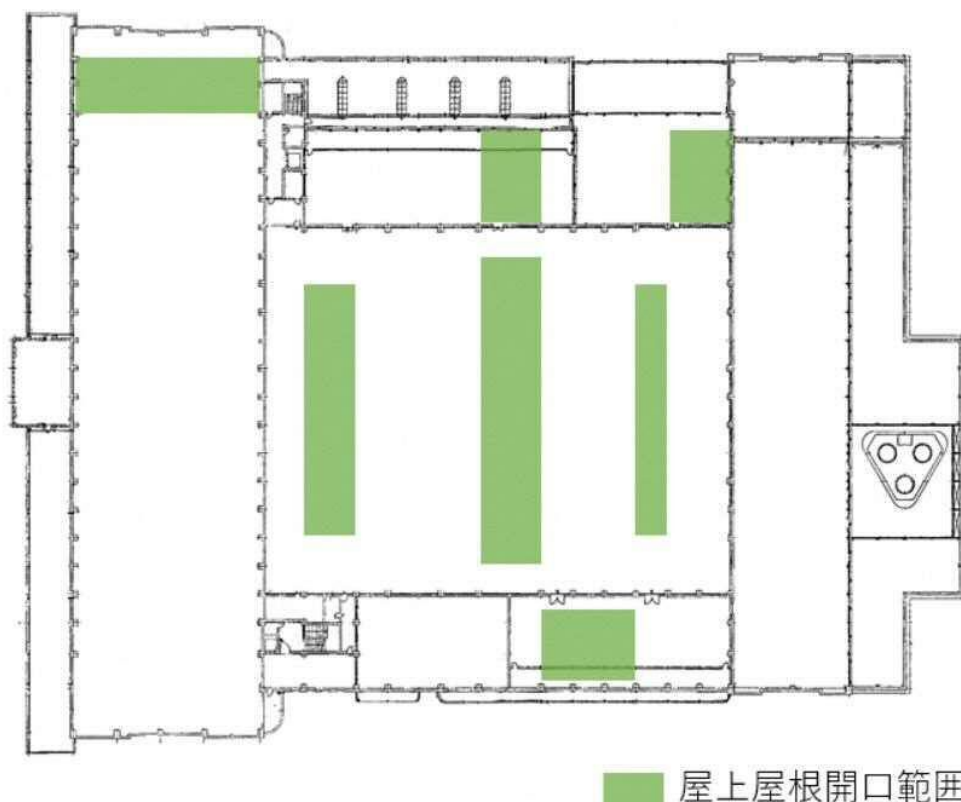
屋上屋根の開口範囲（屋根階平面図）
